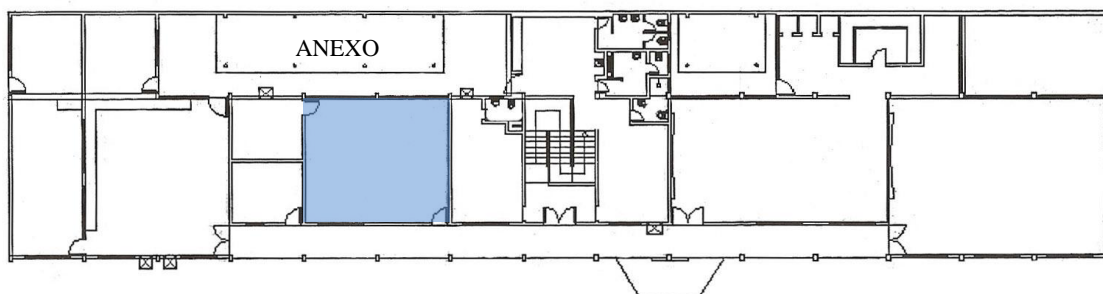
Planta do pav. térreo do Bloco de Construção Civil – sala do estudo em destaque.
